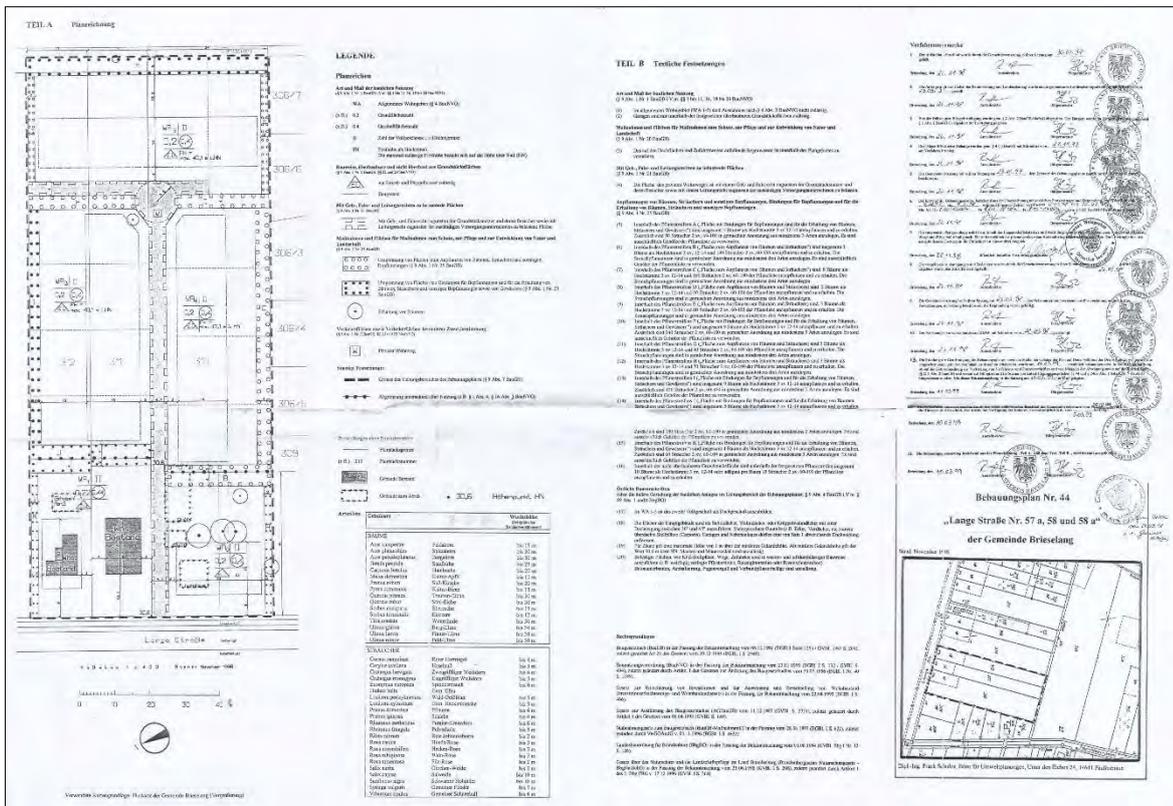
Bebauungsplan Nr. 44 "Lange Straße 57a, 58 und 58a"
